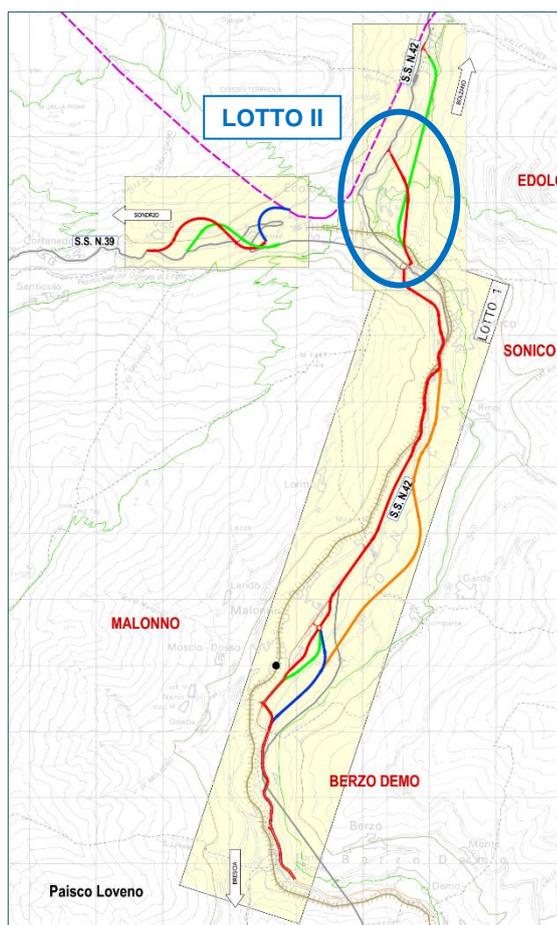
Schema planimetrico tracciati analizzati con il Progetto Preliminare
